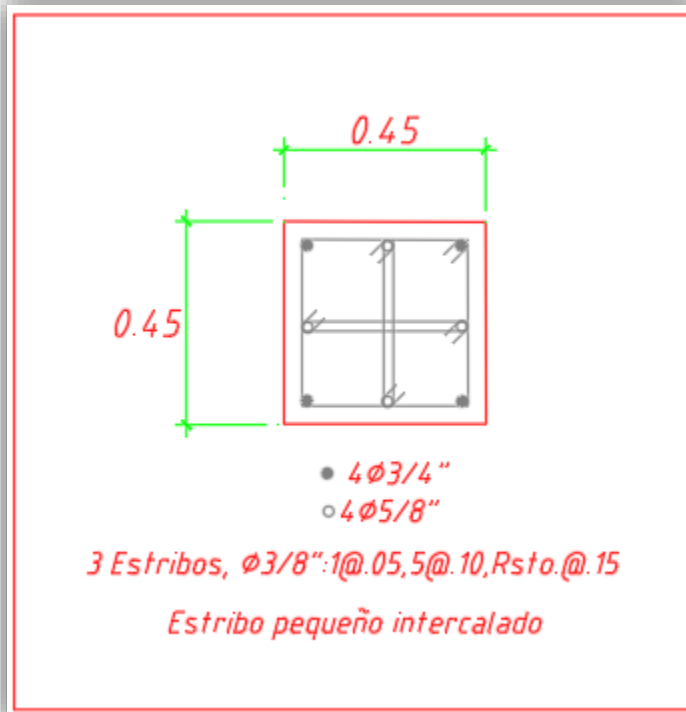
Detalle de refuerzo en columna C1 y C2 piso 4 y 5
